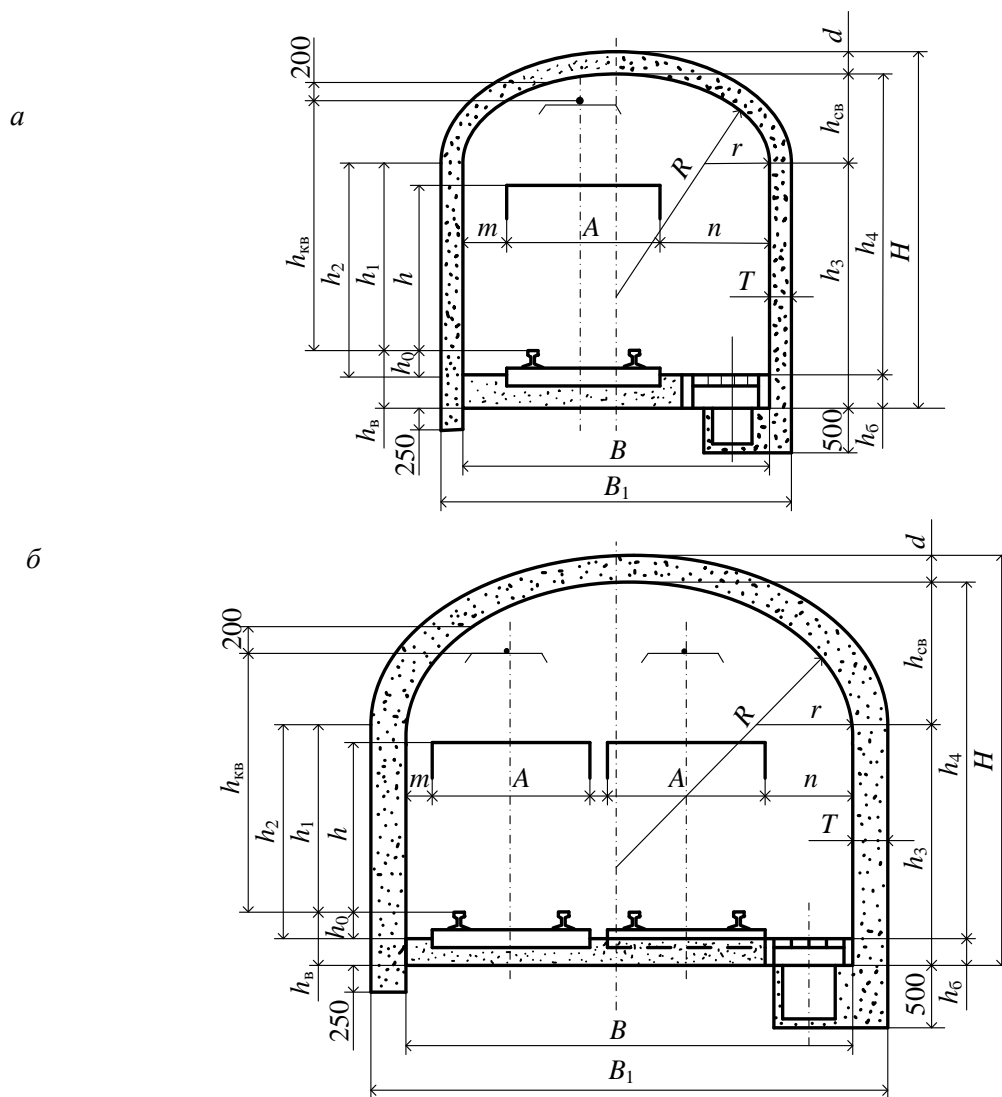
Поперечные сечения выработок прямоугольно-сводчатой формы с монолитной бетонной крепью:
